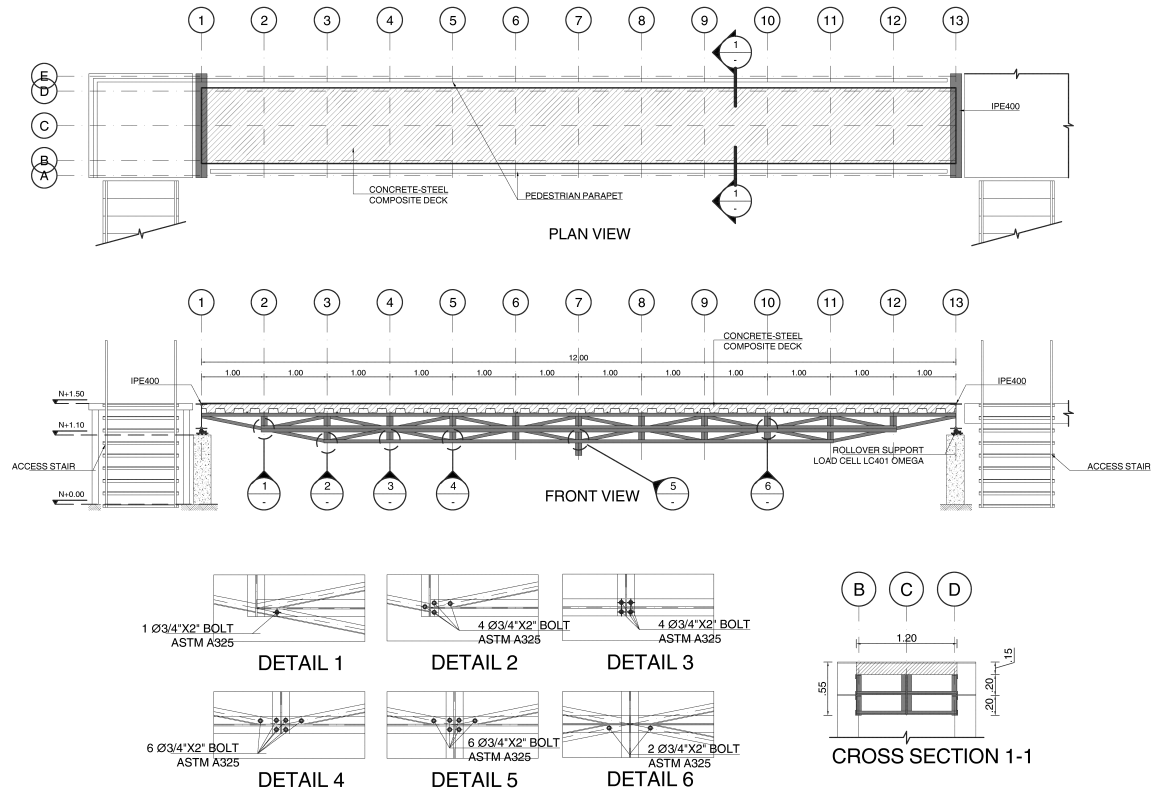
Vista en planta y alzada de la estructura del *UV HSI Footbridge Testbed*.
